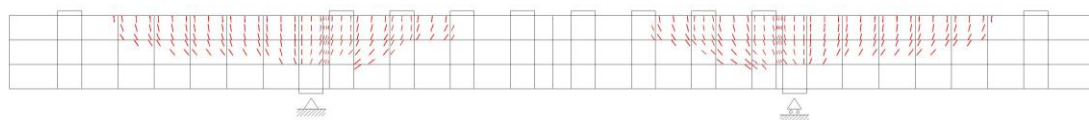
破壊時の変形及びひび割れ状態 (Case No. 14)
